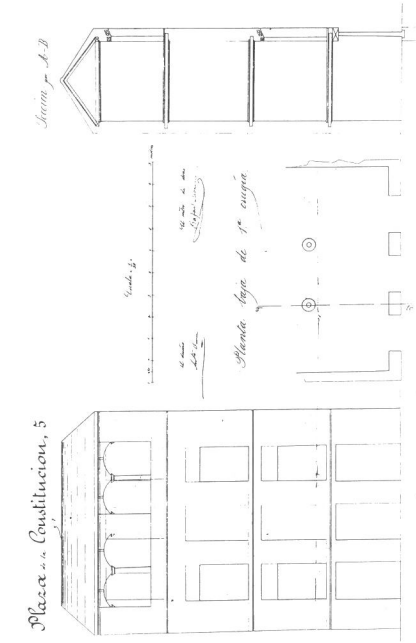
Proyecto de planta y alzado para Pza. Constitución nº 8, R. Moreno, 1868.
